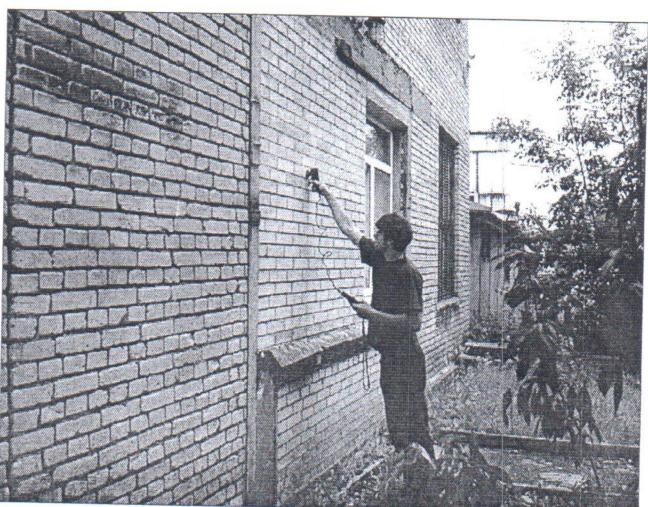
Фрагмент испытываемой стеновой конструкции, размещенной в проеме существующего здания
